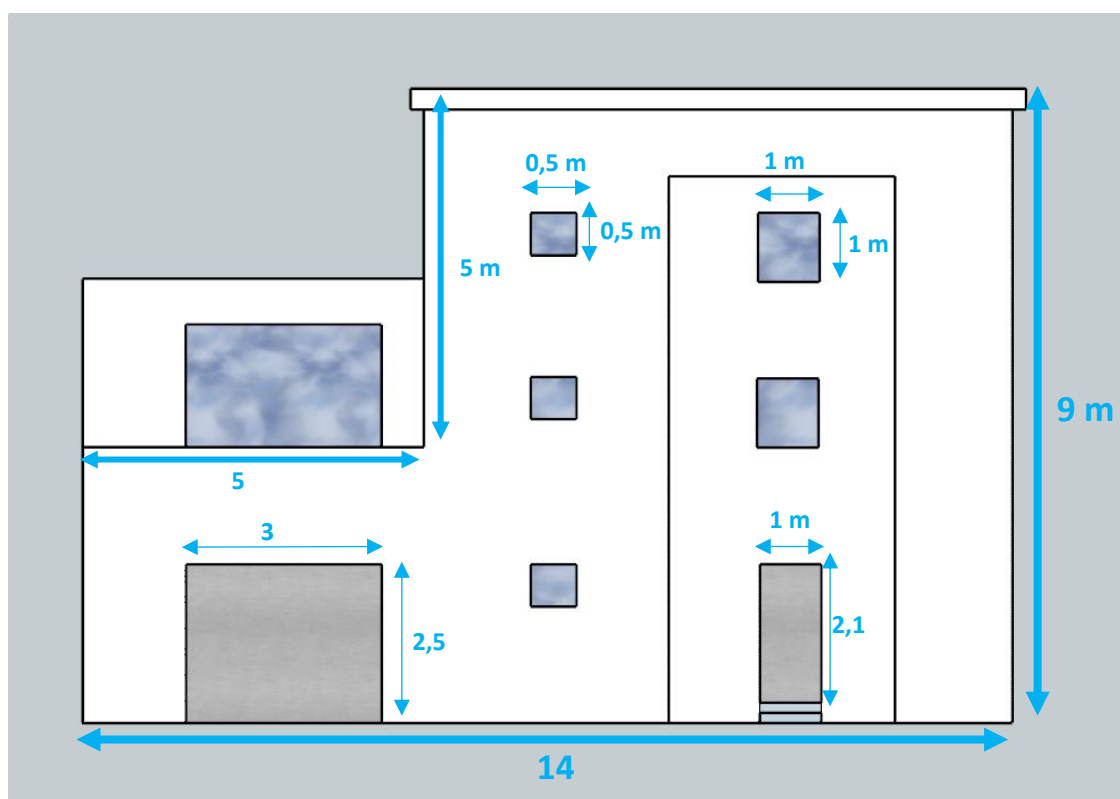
Schéma détaillé de la façade principale de la maison (façade nord) Traitée par l'auteur
